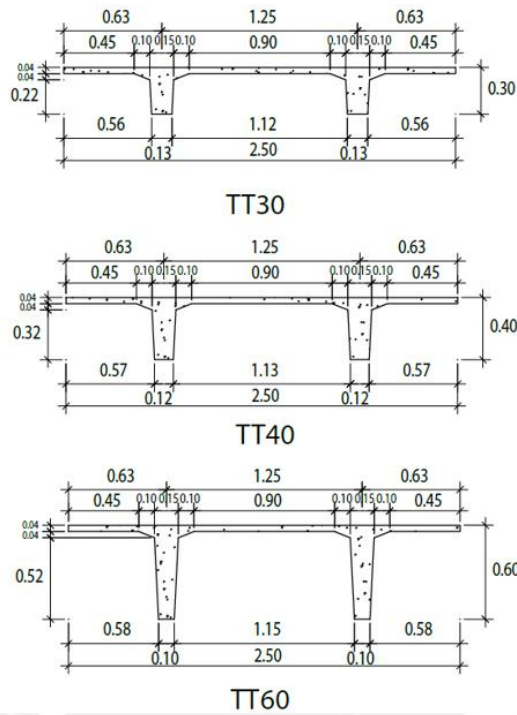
Sección de losa TT 30, TT40 y TT60.
